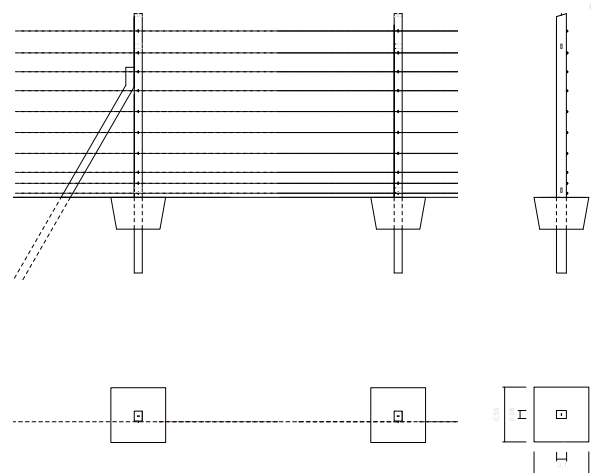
Peenemünde, Zaunpfosten Typ 16 mit Typ 16a
